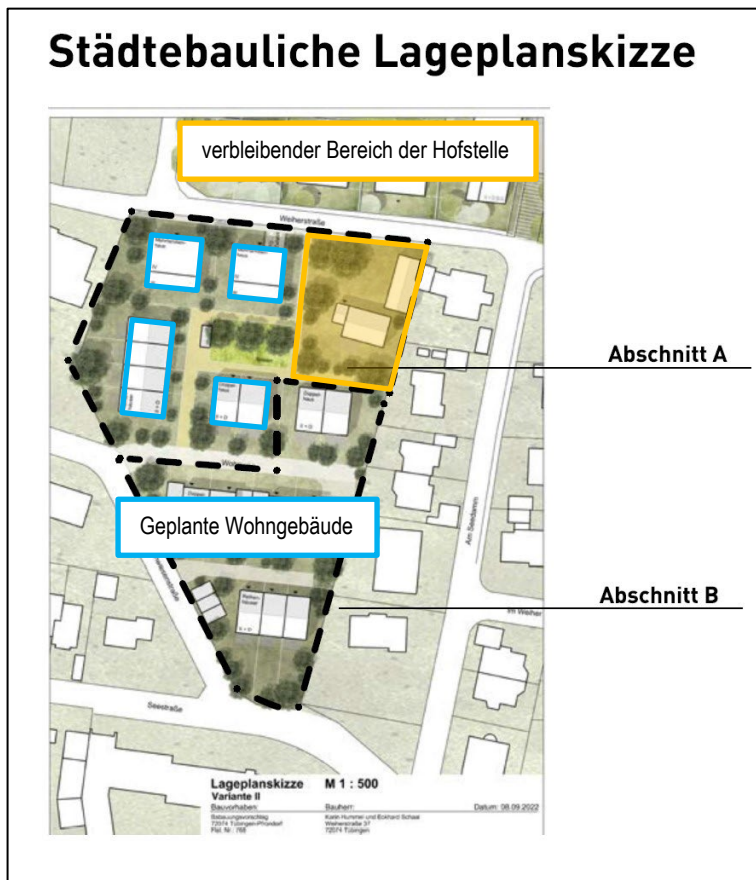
Städtebauliche Lageplanskizze (12.07.2023)
